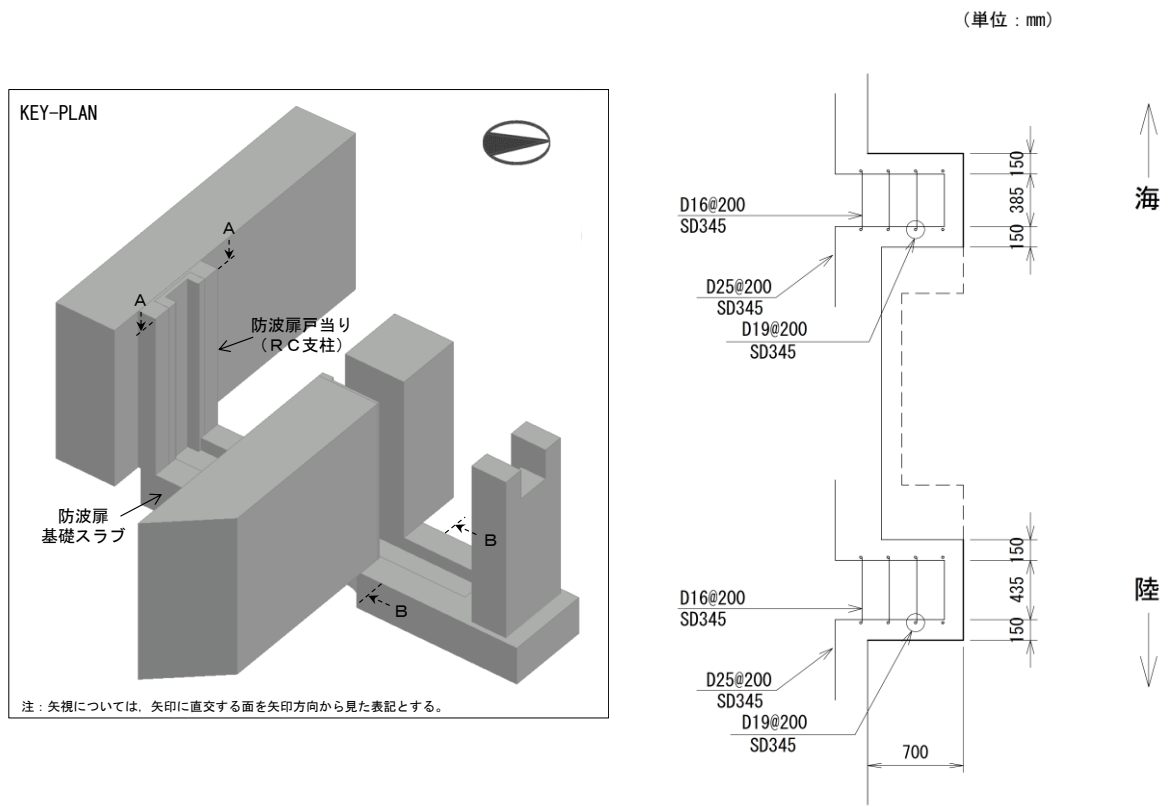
防波扉当り (RC 支柱) の概略配筋図 (A-A 断面)
